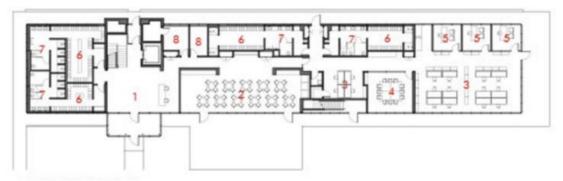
Planta Baixa Térreo com o croqui dos espaços.
